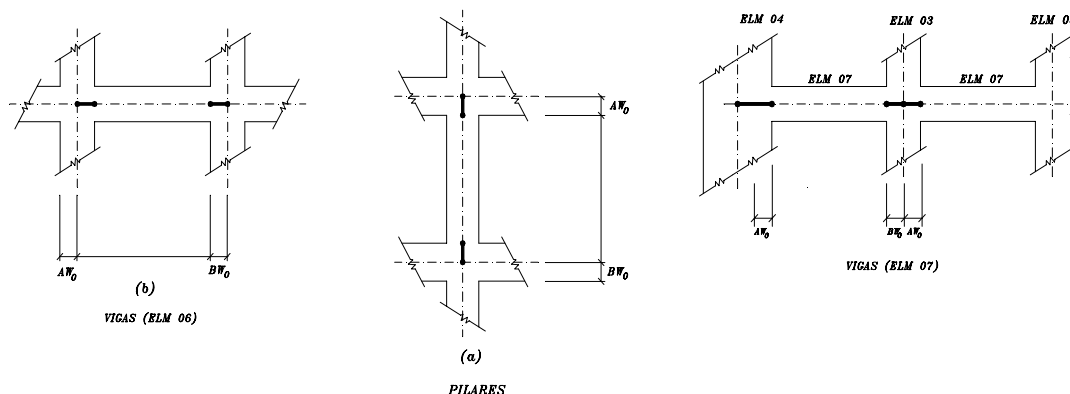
Formação de trechos rígidos nas vigas e pilares da estrutura modelo (exemplo 4)
